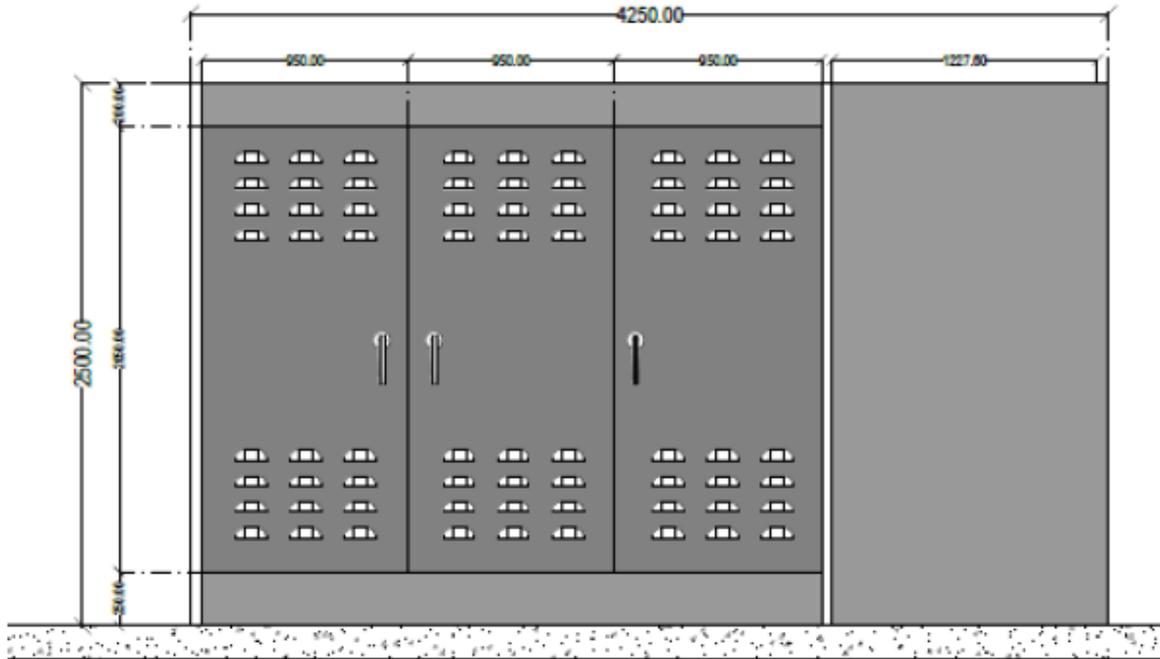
VISTA FRONTAL DEL EQUIPO DE DESCOMPRESIÓN
